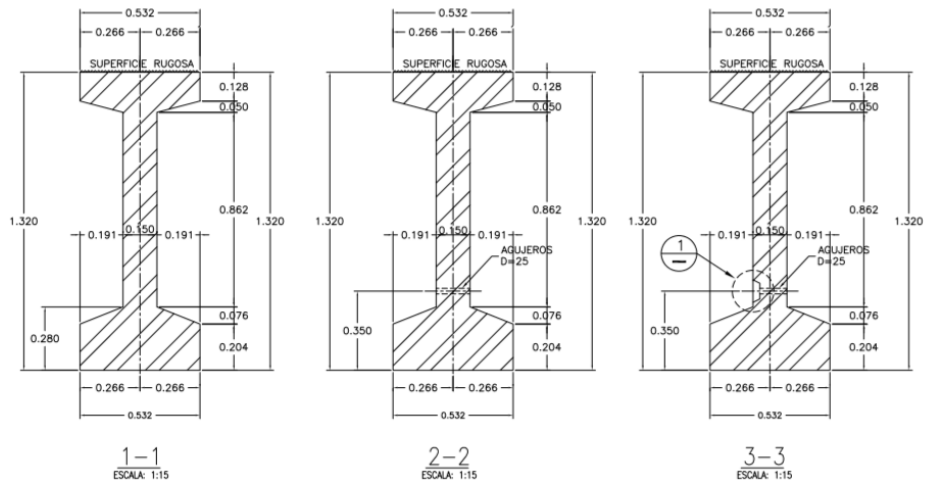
Detalles de Dimensionamiento Vigas Puente WS-80.
